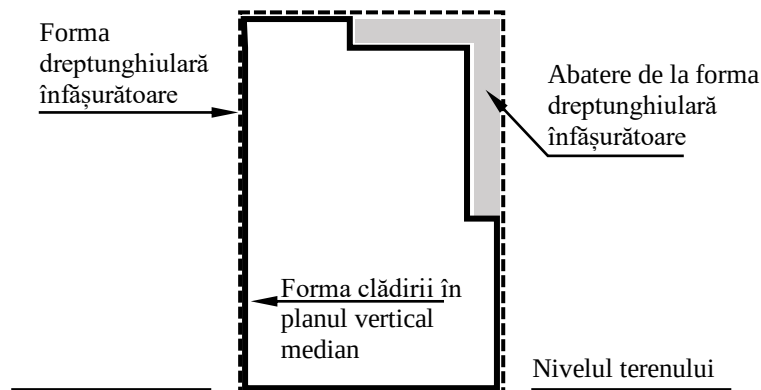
Schiță informativă privind evaluarea abaterilor de formă în plan vertical
